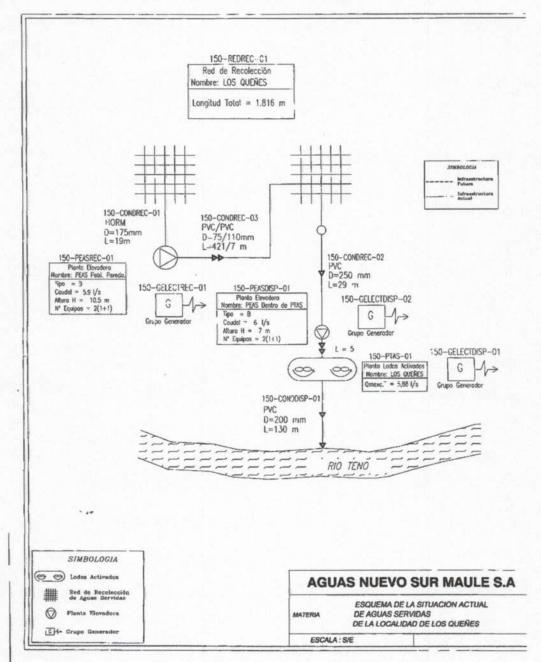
Esquema sistema Alcantarillado Los Queñes
